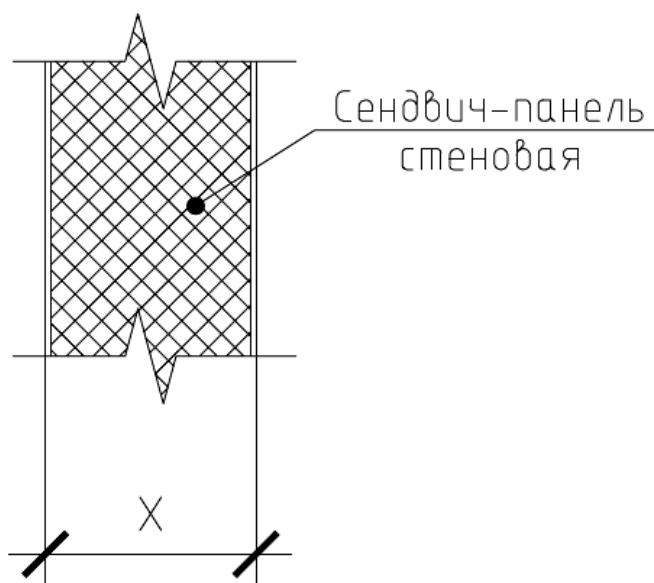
Конструкция наружной стены офисных помещений
